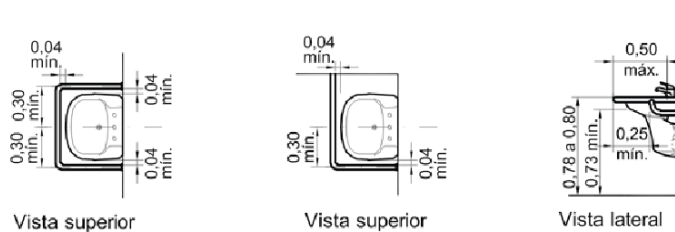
Exemplos de instalação de barras junto ao lavatório
